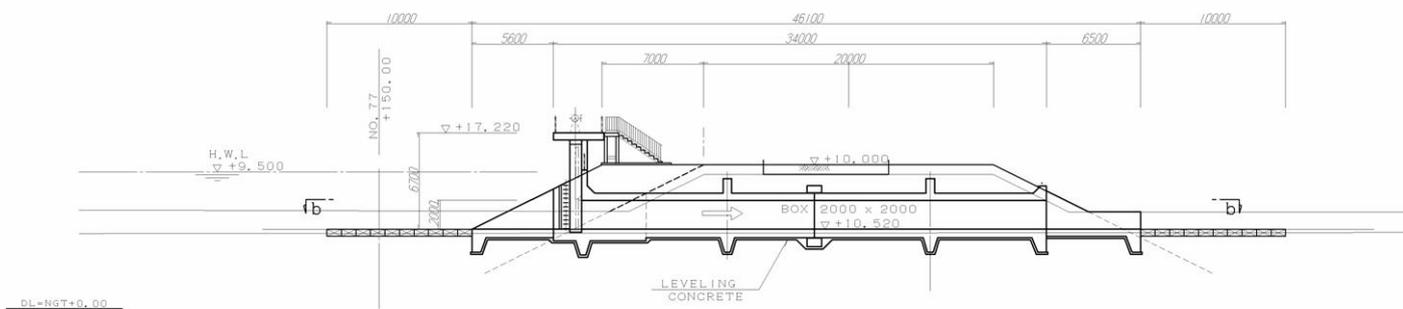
Plan général de l'ouvrage de contrôle de débit (2) Vanne du canal intérieur
